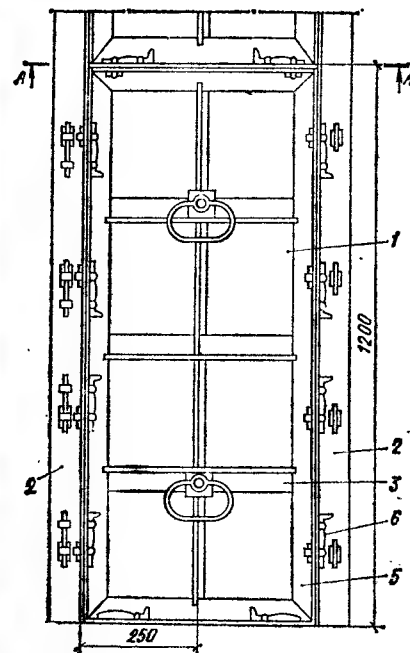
Комбинированная щитовая опалубка для бетонирования колонны и стен жесткости в зданиях из сборно-монолитных конструкций
